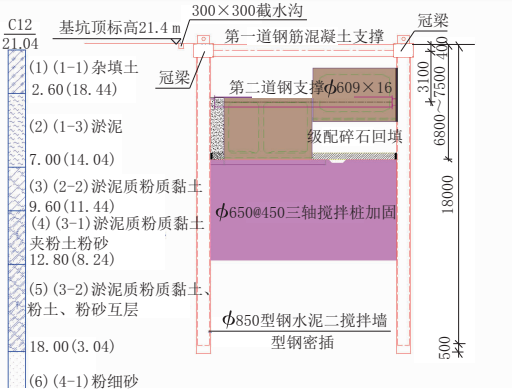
三仓管廊基坑围护结构剖面图(单位:mm)
